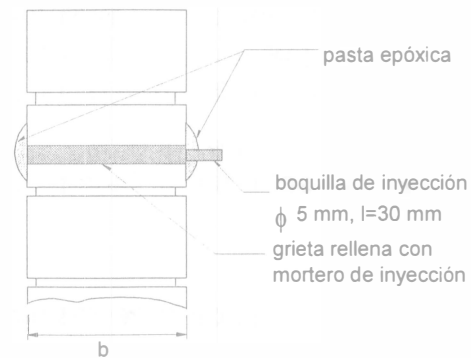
Reparación de grietas en estructuras de mampostería mediante inyección.
